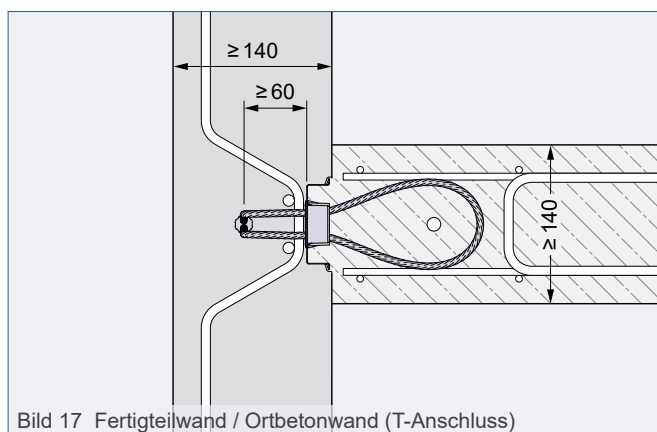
Fertigteilwand / Ortbetonwand (T-Anschluss)
